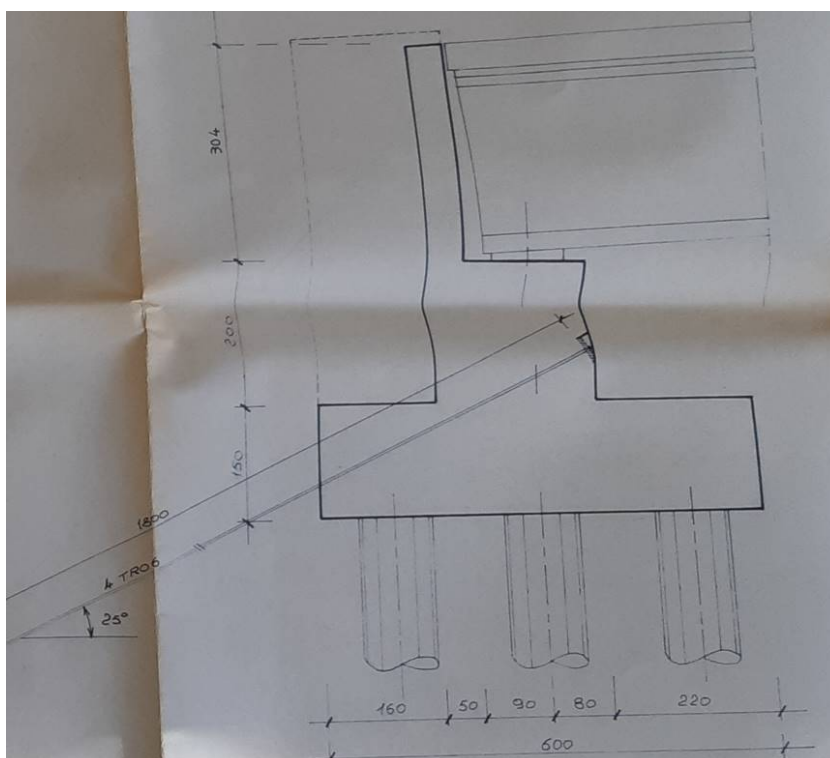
Carpenteria spalla 1 (Sezione longitudinale)
